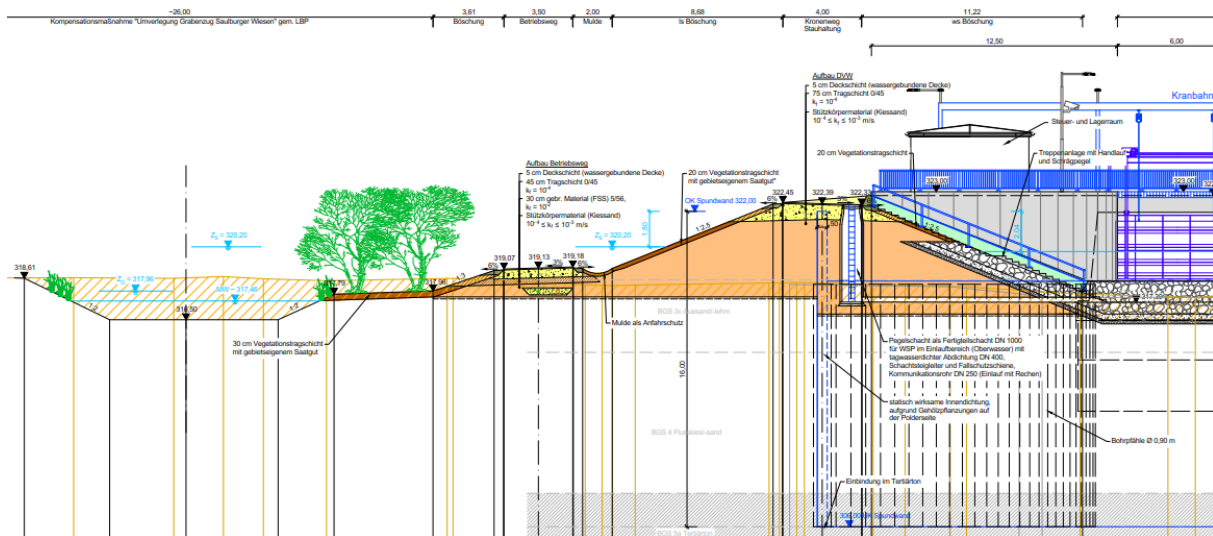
Ersatzneubau Stauhaltungsdamm, Querschnitt bei Station 0-100 (aus Plan 04-01-04, Blatt 1/4)
